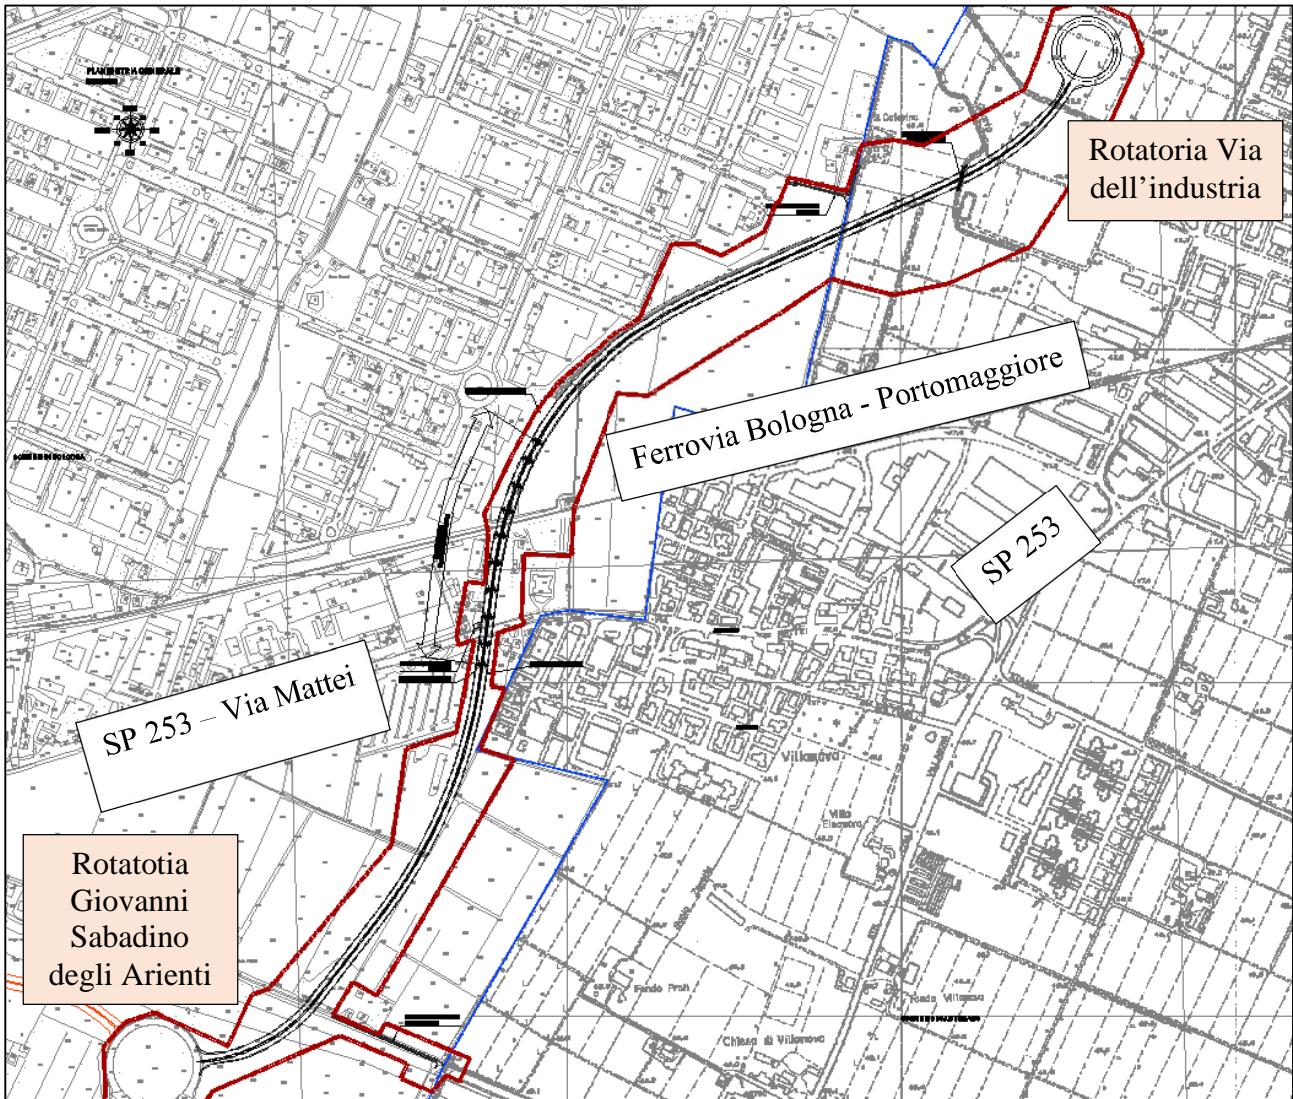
Planimetria generale della nuova viabilità Lungo Savena III lotto
